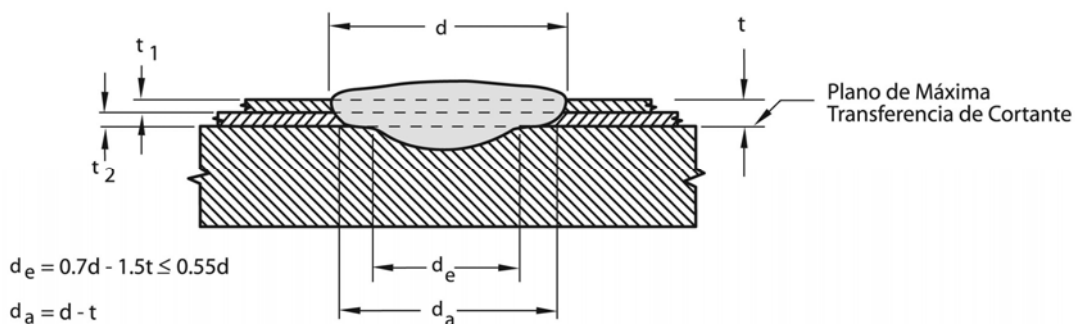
Soldadura de tapón — Doble espesor de lámina
